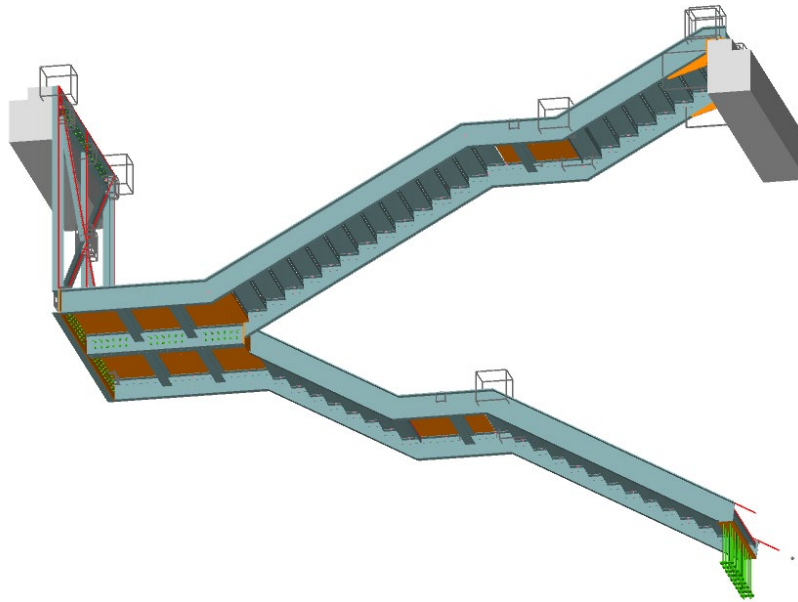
Viste assometriche della struttura della scala centrale parzialmente appesa
